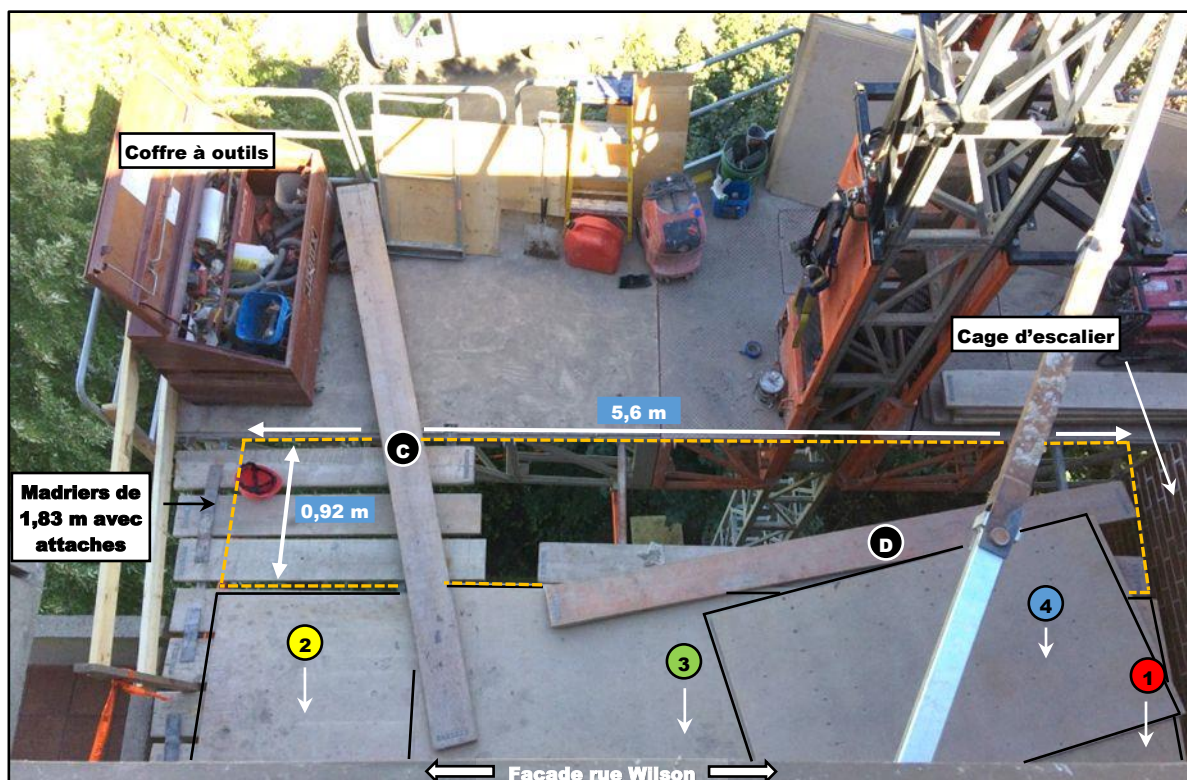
Vue en plongée sur la partie avant de la plate-forme de travail. (Source : CNESST)
